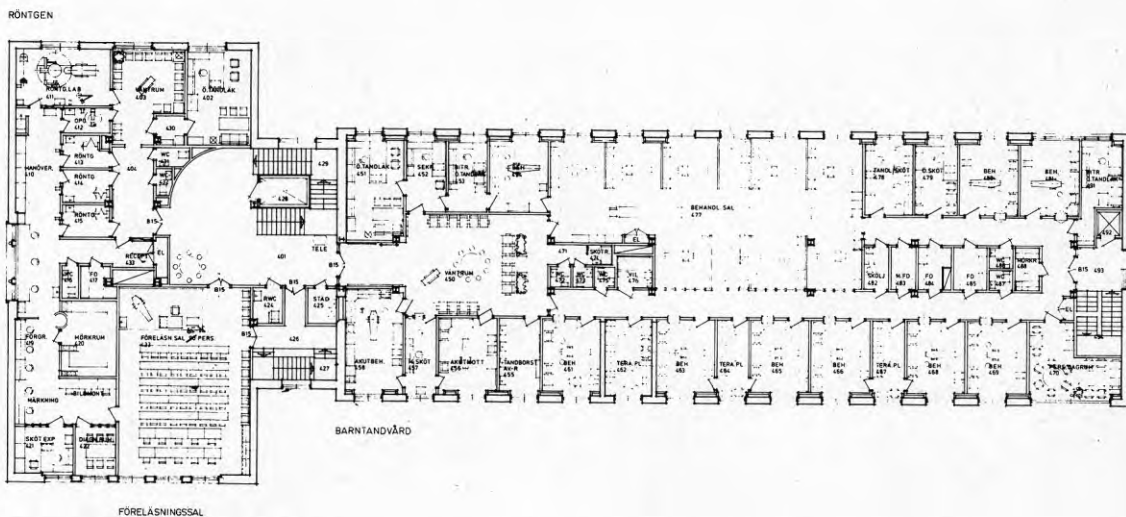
Plan 4 (våningen 1 trappa upp) efter ombyggnad.
